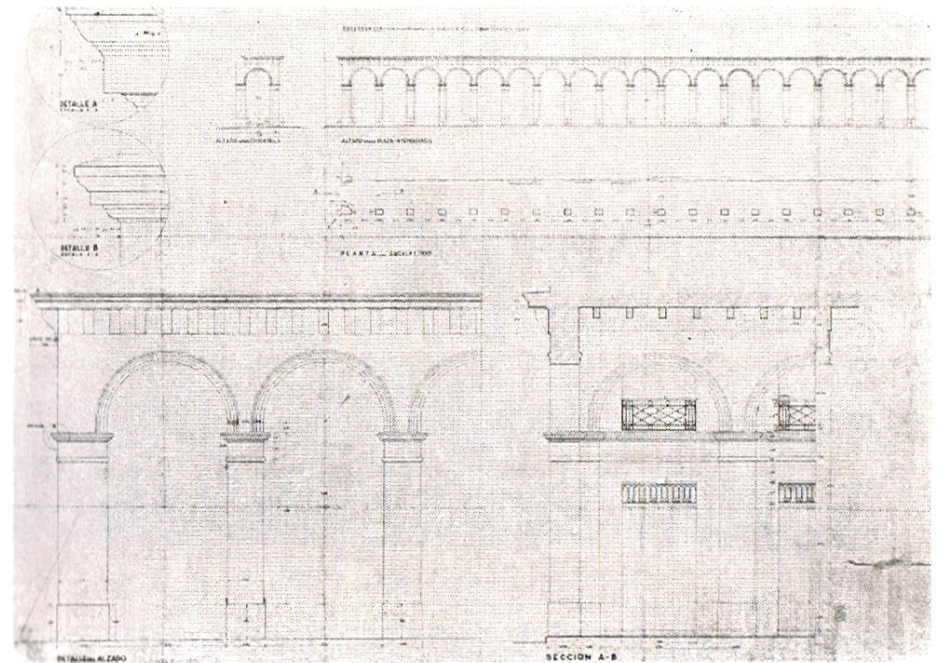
Casa de Elías Gil (Arquerías de la Pasiva) Planta, corte y fachada.
